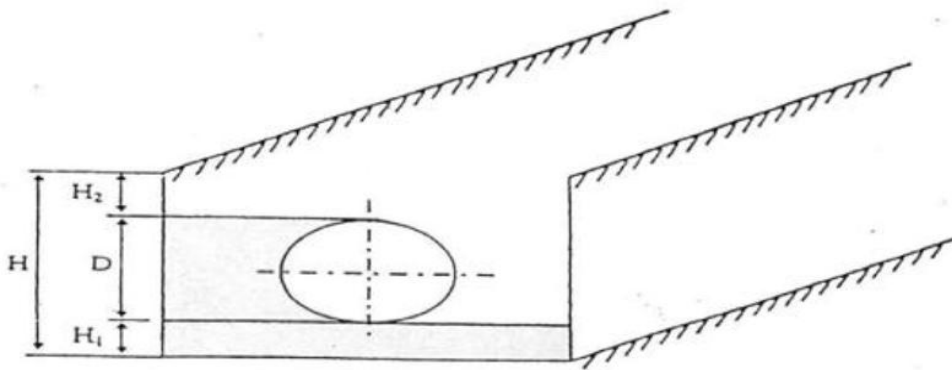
Schéma d'une tranchée avec une conduite circulaire.
